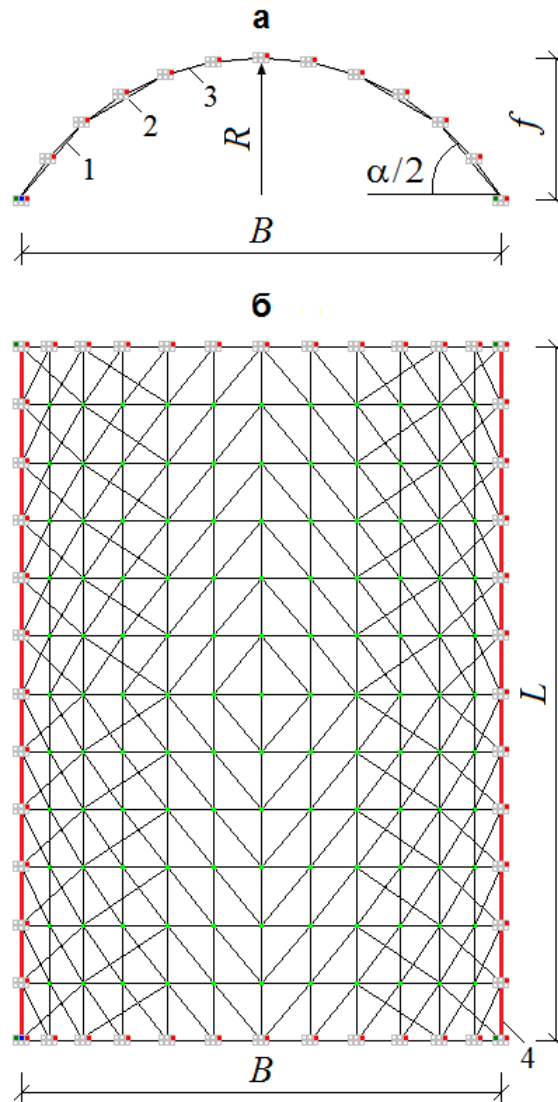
Схема подкрепленной сетчатой оболочки: а – вид с торца; б – вид сверху; 1 – диагональный элемент; 2 – связь в торцевом опорном узле; 3 – элемент грани; 4 – опорное ребро повышенной жесткости
